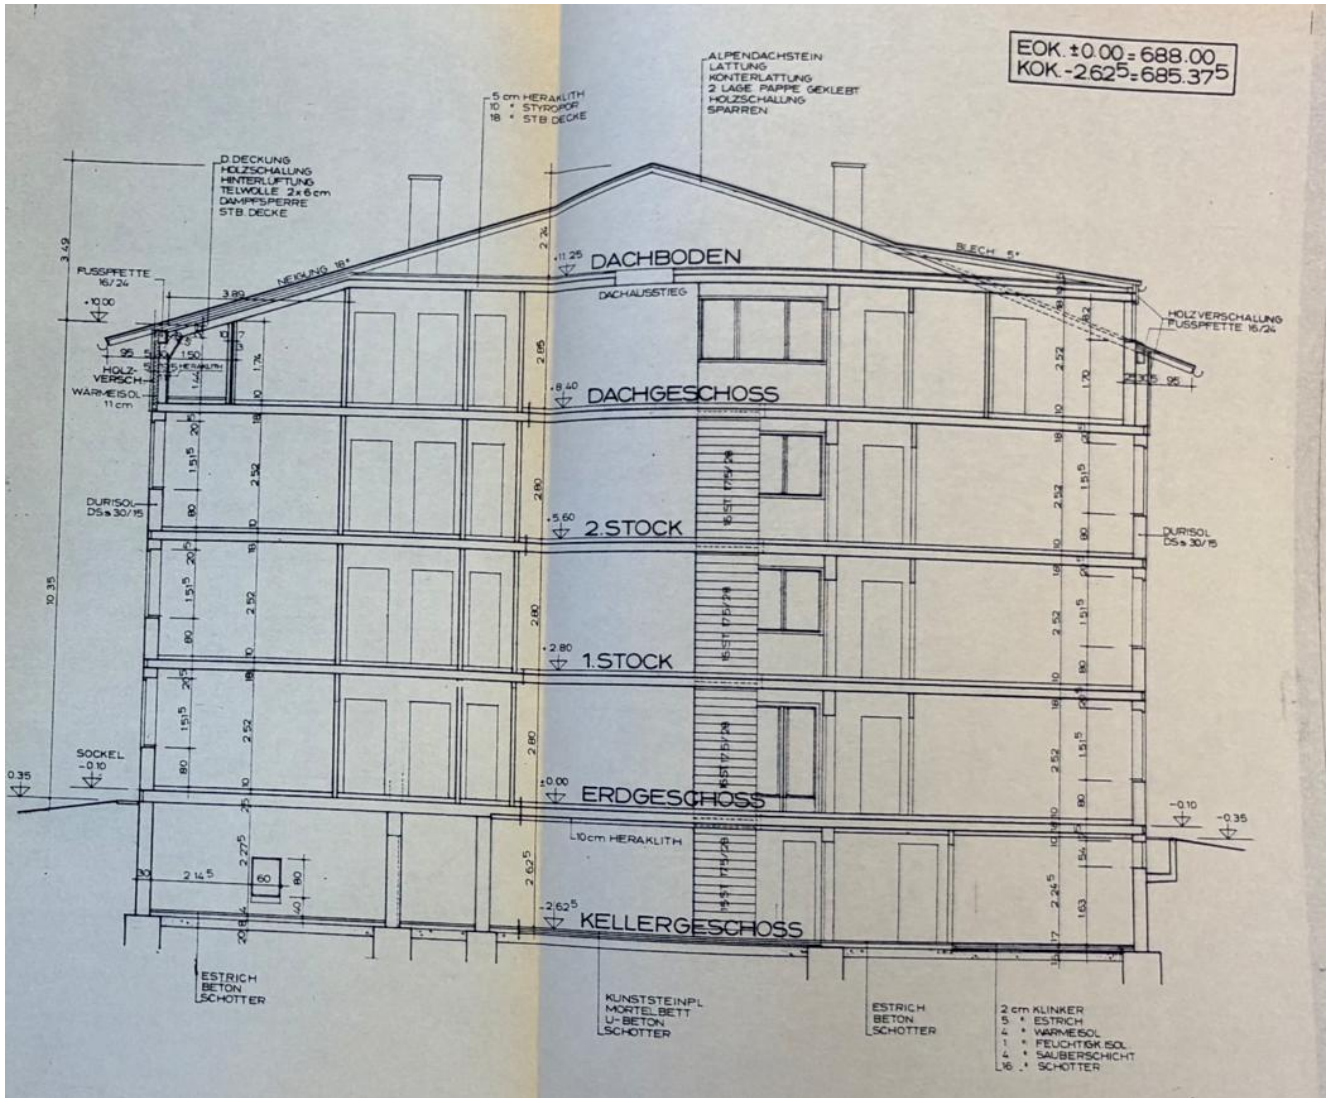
Schnitt Gebäude. Bestandsplan v. 22.10.1987
